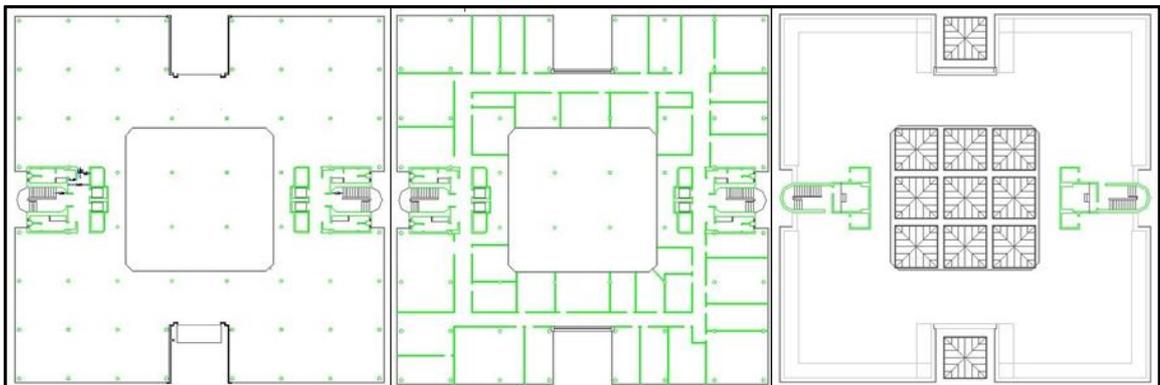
Vista en planta de planta segunda (izquierda), tercera (centro) y azotea (derecha).
